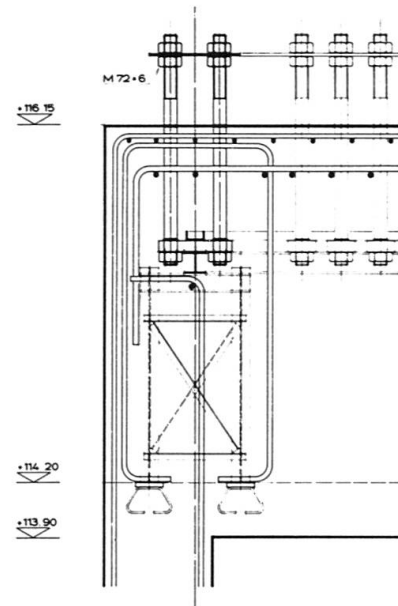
Anschluss des Stahlrostes an den Betonpylon
